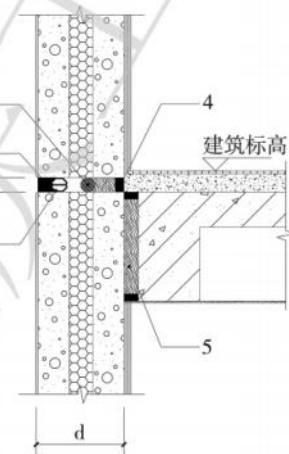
外挂墙板水平缝防水构造示意图-2
